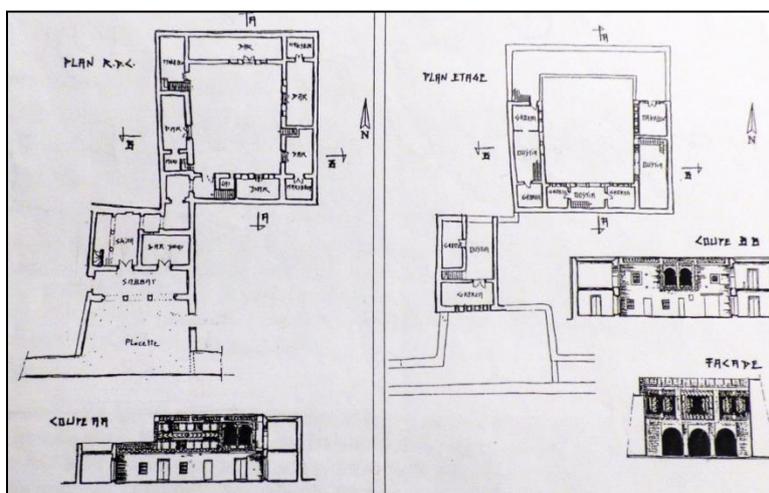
Vue en plan de Houch à Nafta (RDC)
